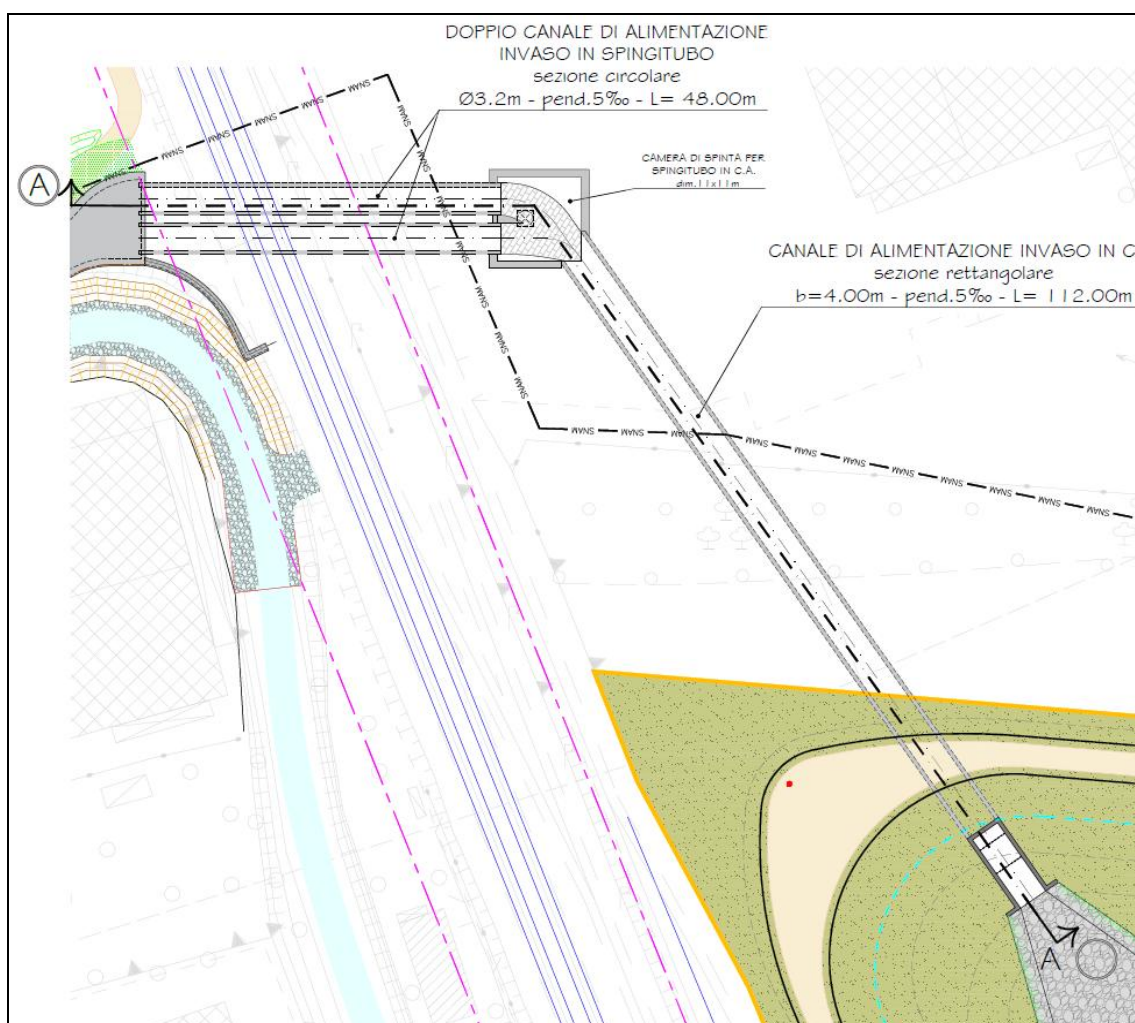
Planimetria di progetto del canale di alimentazione dell'invaso
